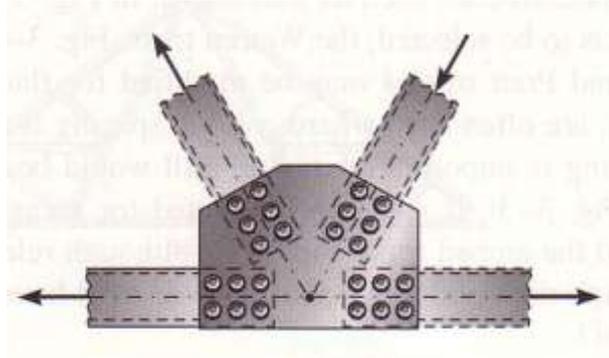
Elemen batang sebagai elemen kolom dan elemen balok kolom
